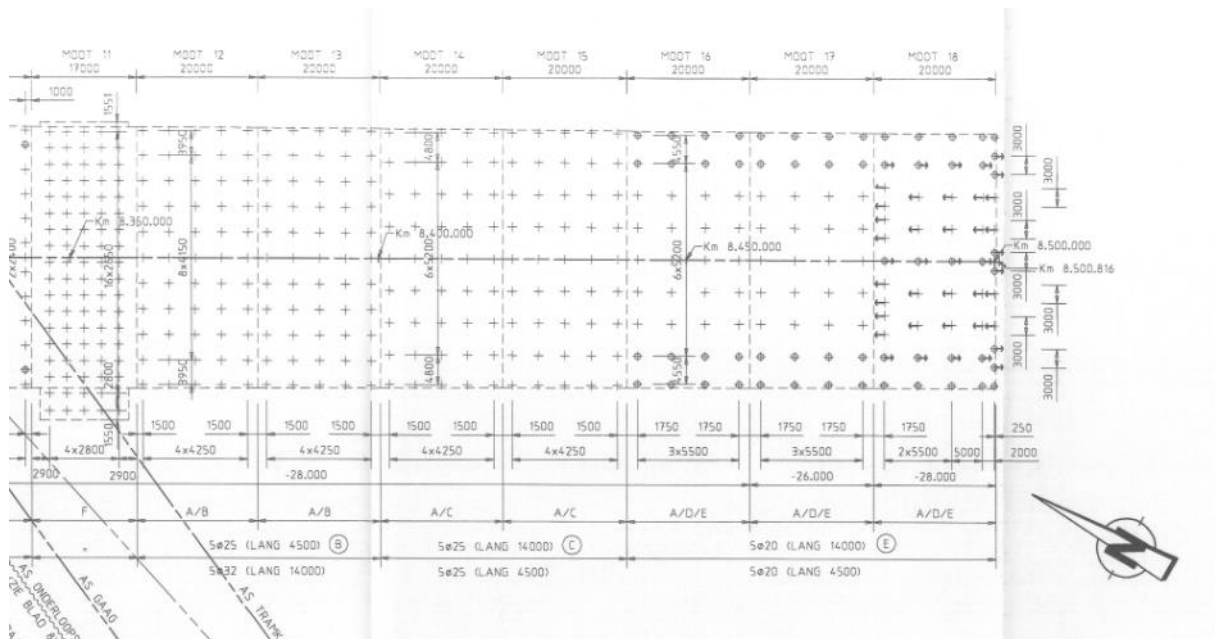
Bovenaanzicht gewapend betonnen bakconstructie zuidelijk toerit (bron: tekening AGA-15).
